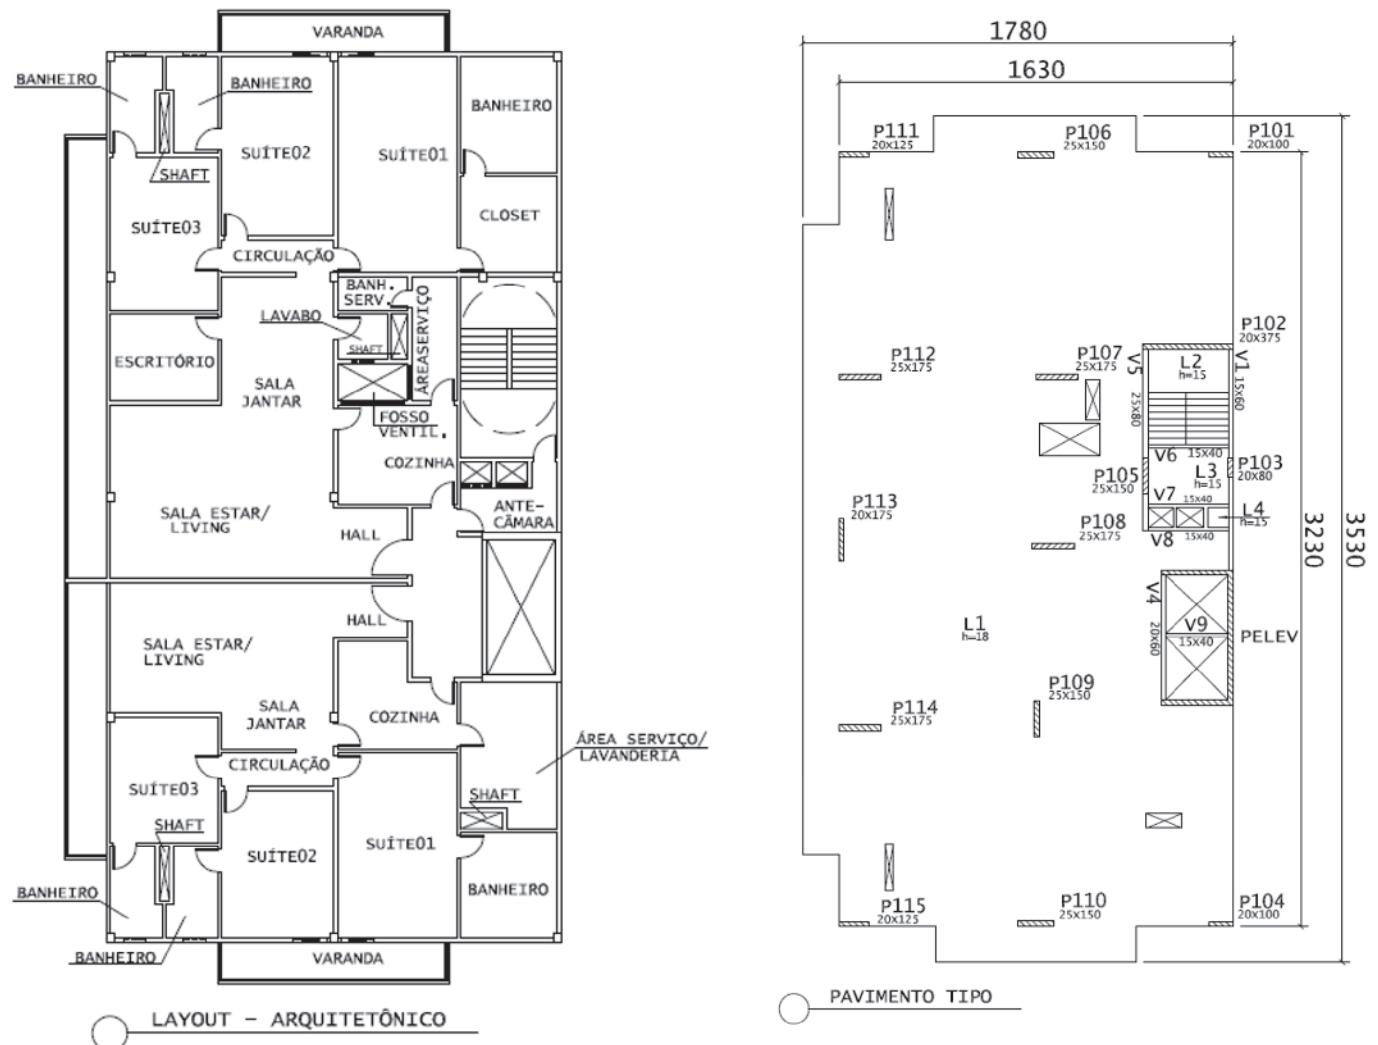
Layout arquitetônico e lançamento estrutural do pavimento tipo
